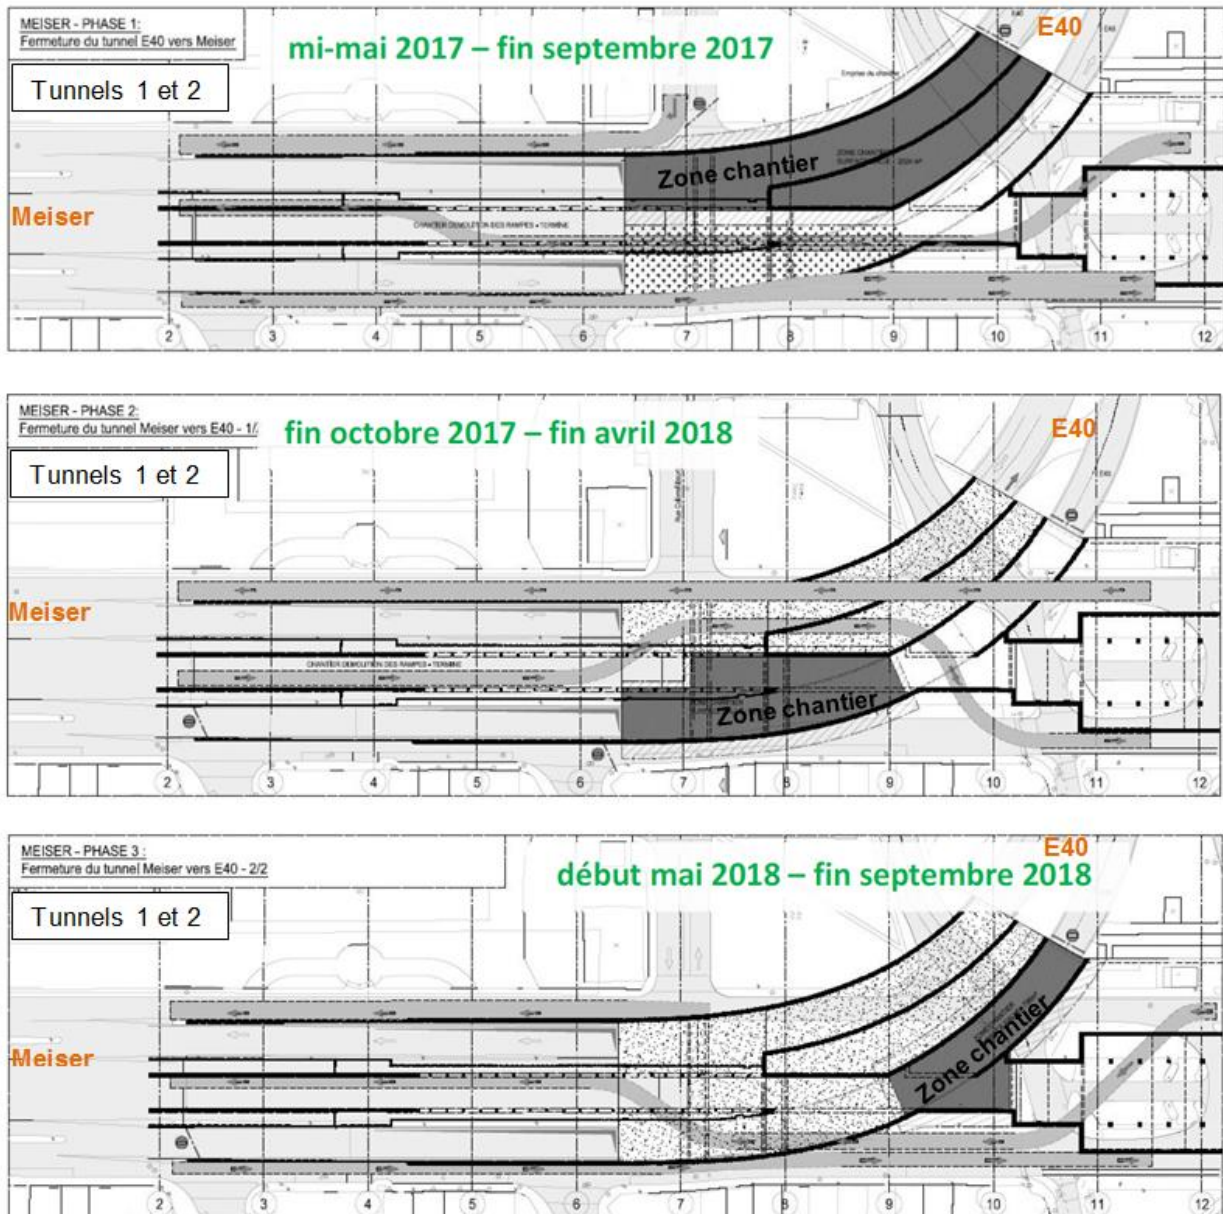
Phasage des travaux au niveau des tunnels 1 et 2 (côté Meiser)
